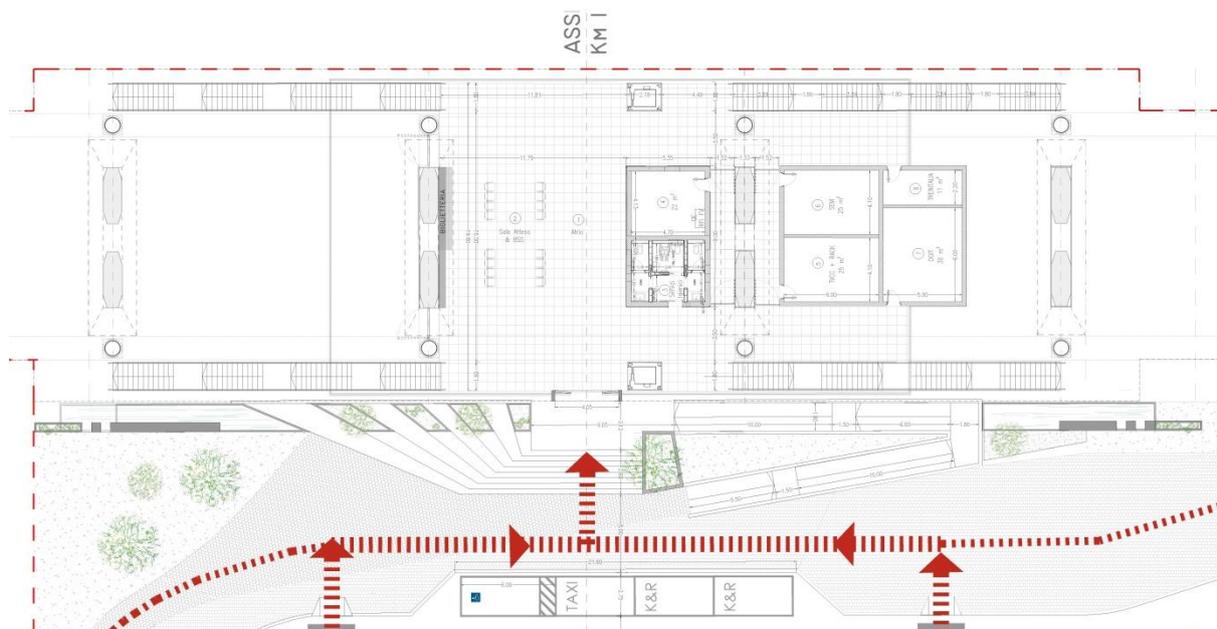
Pianta piano terra e accesso dal piazzale antistante
